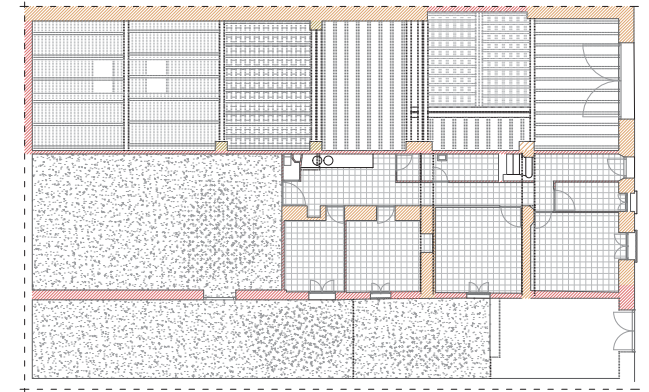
Estancia de vivienda en planta baja (Fuente: elaboración propia)
